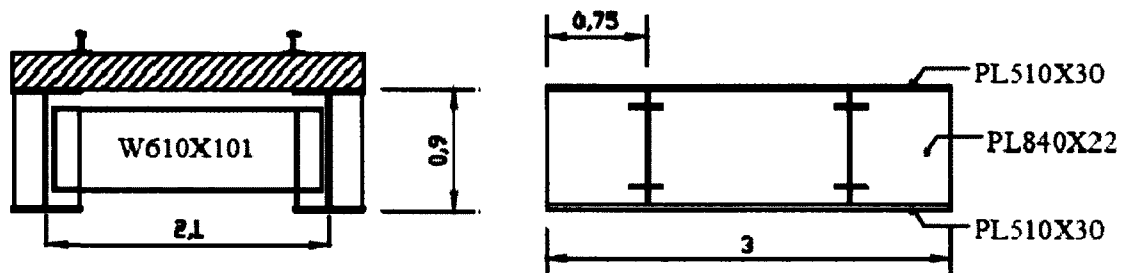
Pont bi-poutres - Section transversale et élévation - Section D
